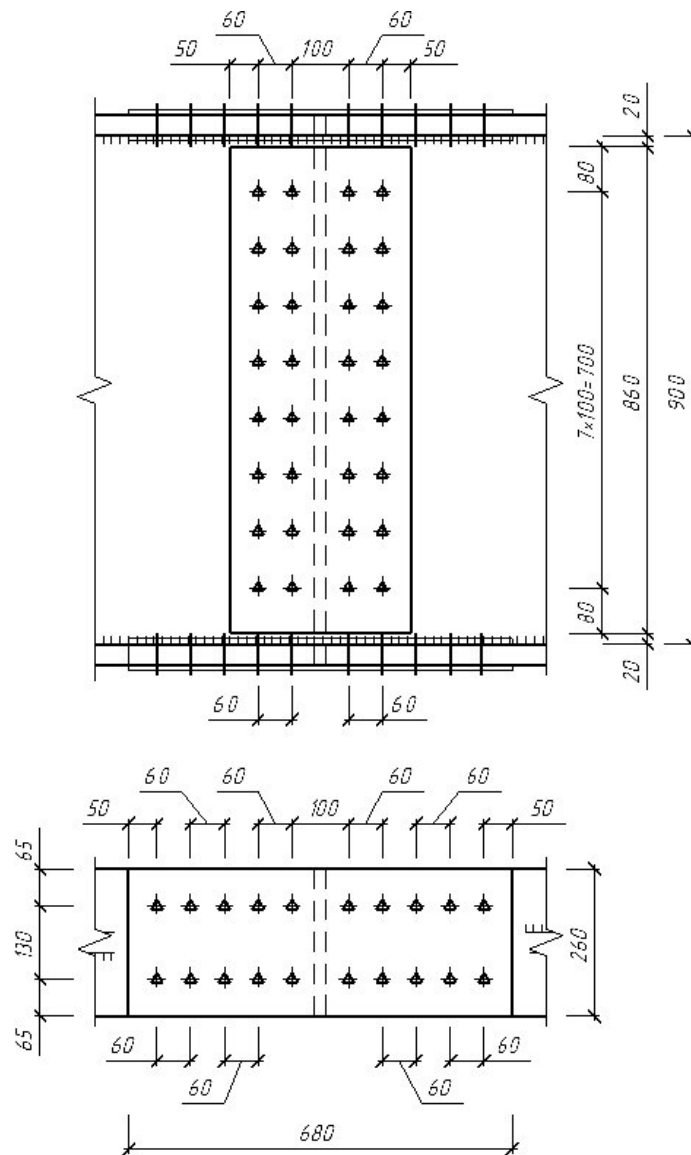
Размещение болтов на монтажном стыке главной балки
